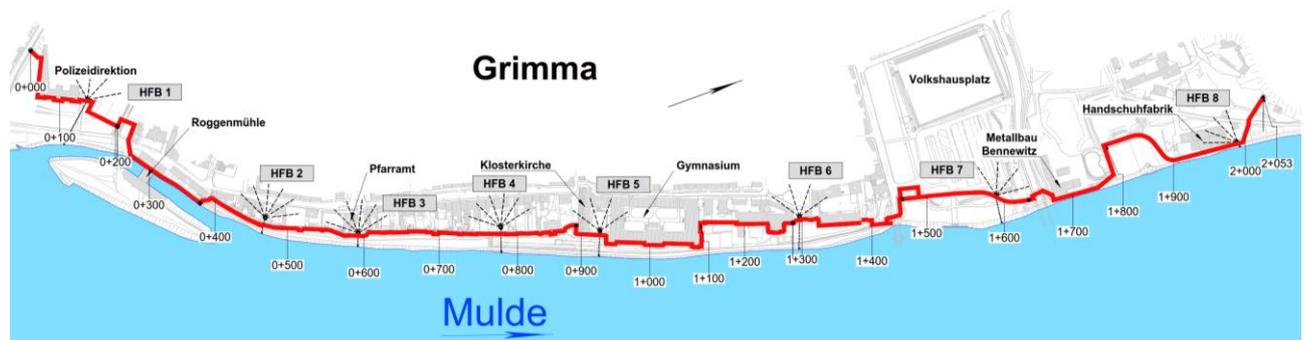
Übersichtslageplan der Schachtstandorte
